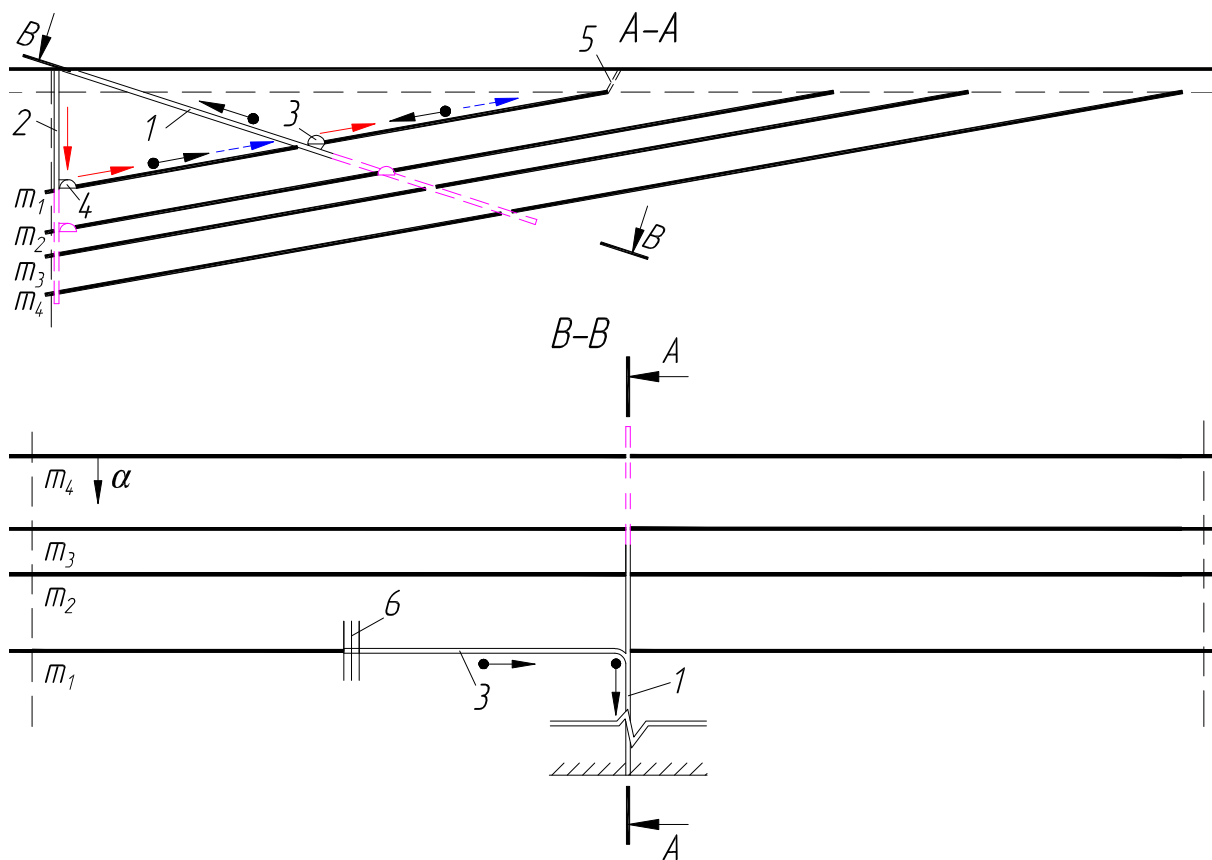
Комбинированное вскрытие без дополнительной вскрывающей выработки с проведением наклонного ствола в крест линии падения;
